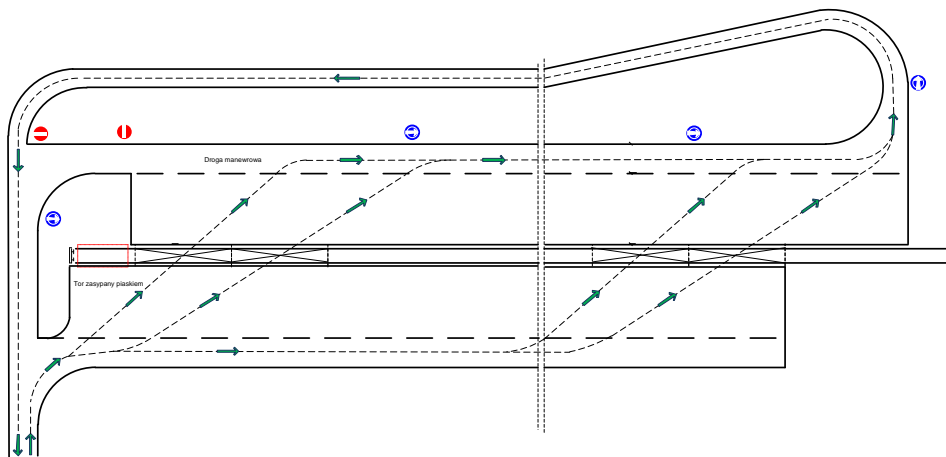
Przypadek „a” – organizacja ruchu – załadunek
